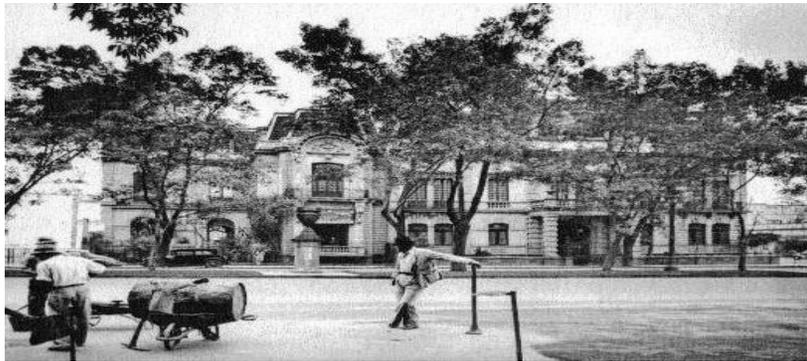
En los años treinta se emprendieron trabajos de pavimentación acordes a la mayor carga vehicular.
